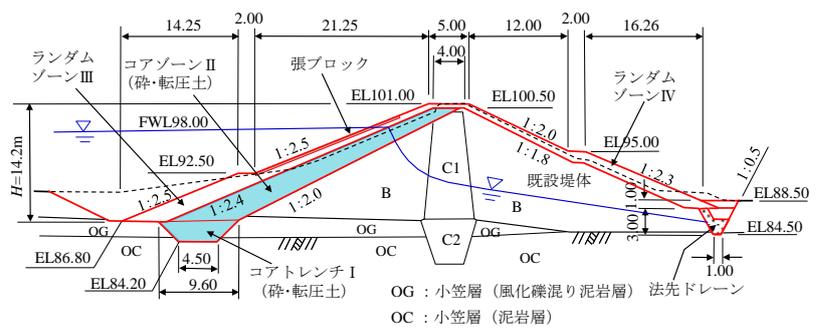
西大谷ダムの改修前・後の標準断面<sup>9)</sup>
